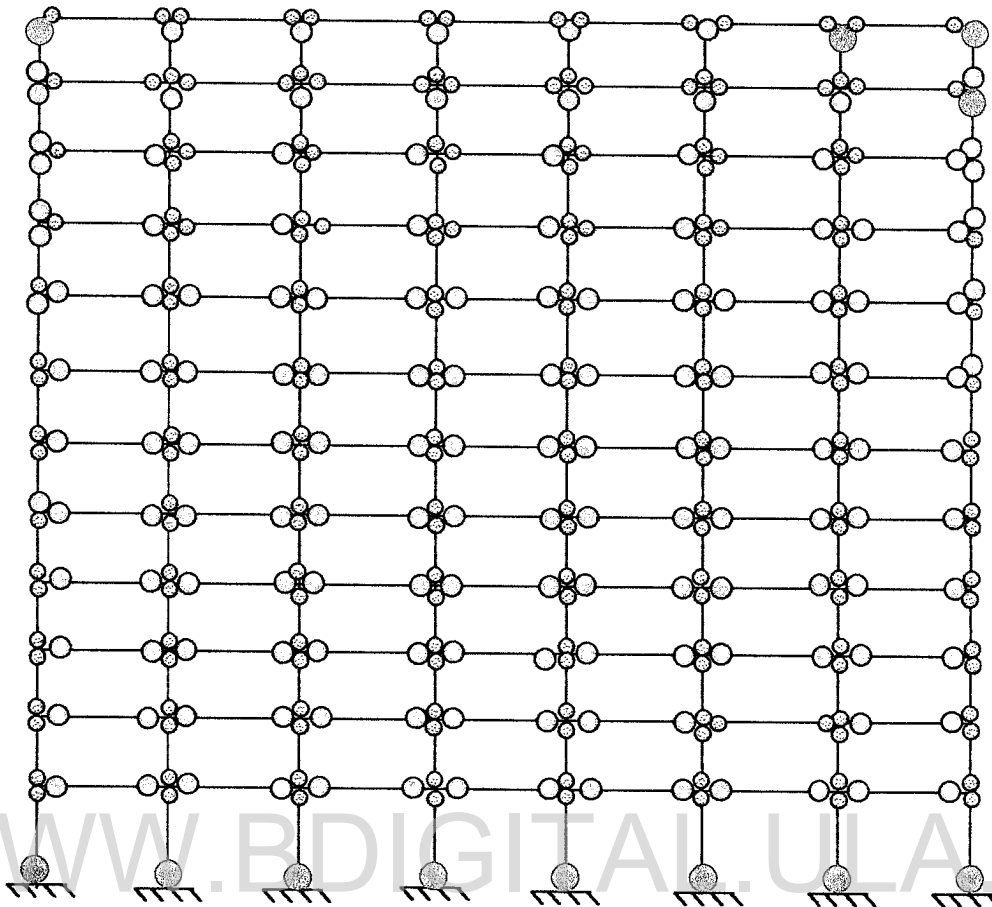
Mapa de Daños en las vigas y columnas del pórtico de vigas planas
